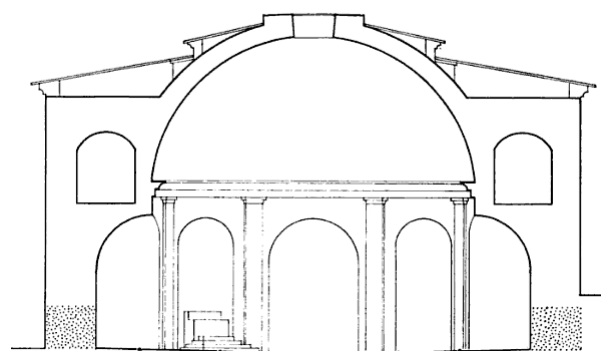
Sección del pavimento de *Santa Maria della Rotonda de Albano*¹⁷¹
